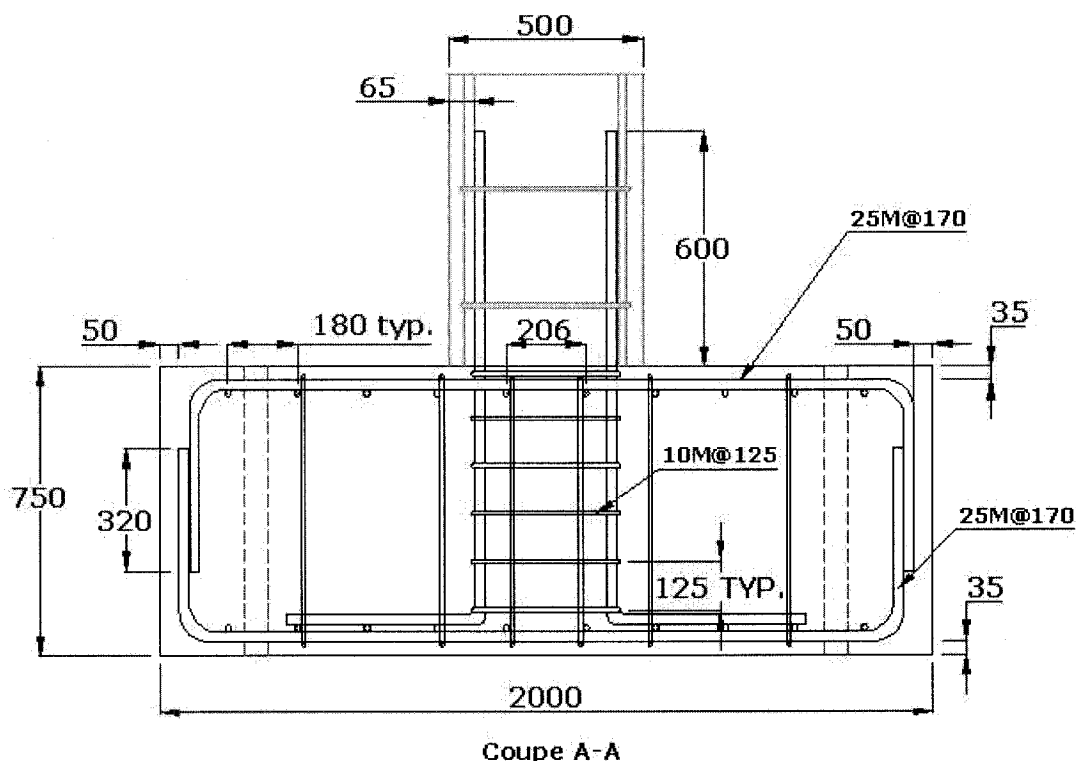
Vue en élévation de la coupe A-A des semelles [mm]
